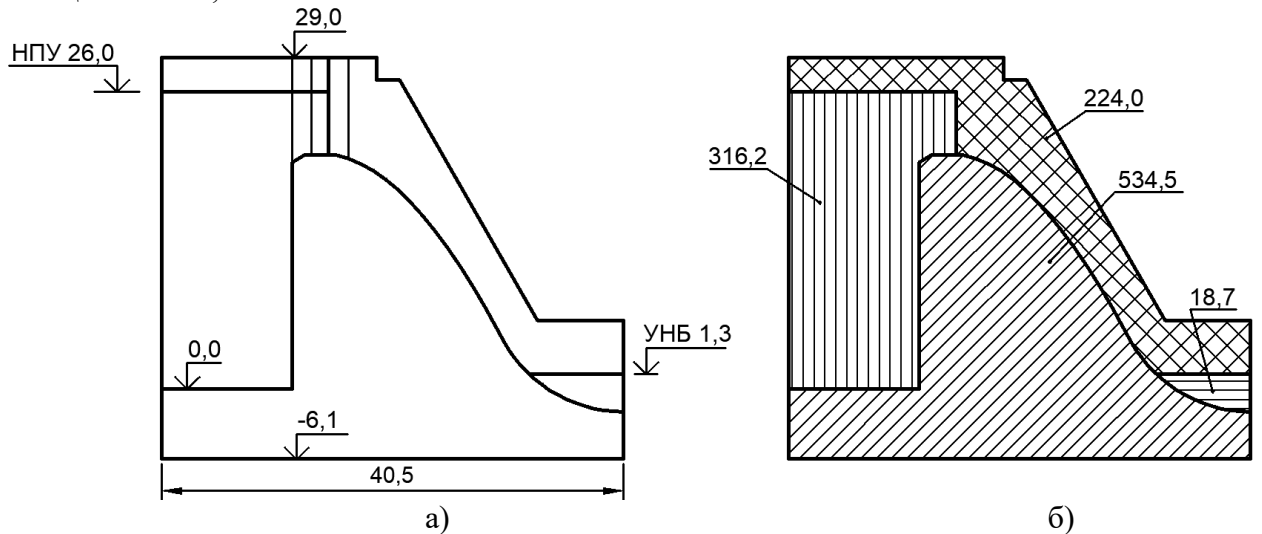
Исходные данные к расчёту нагрузок на бетонную водосливную плотину
